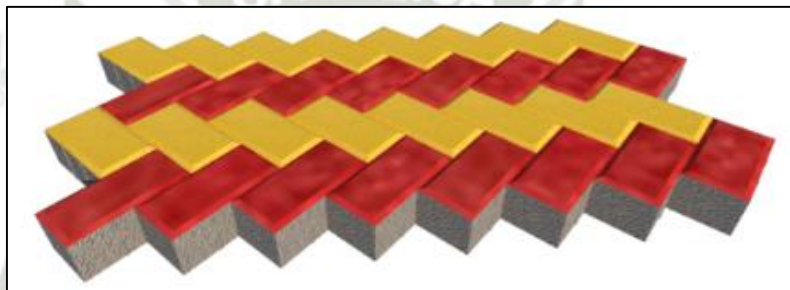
Elemento constructivo rectangular de concreto para pavimentación y adoquinado (Adoquín de concreto rectangular)
